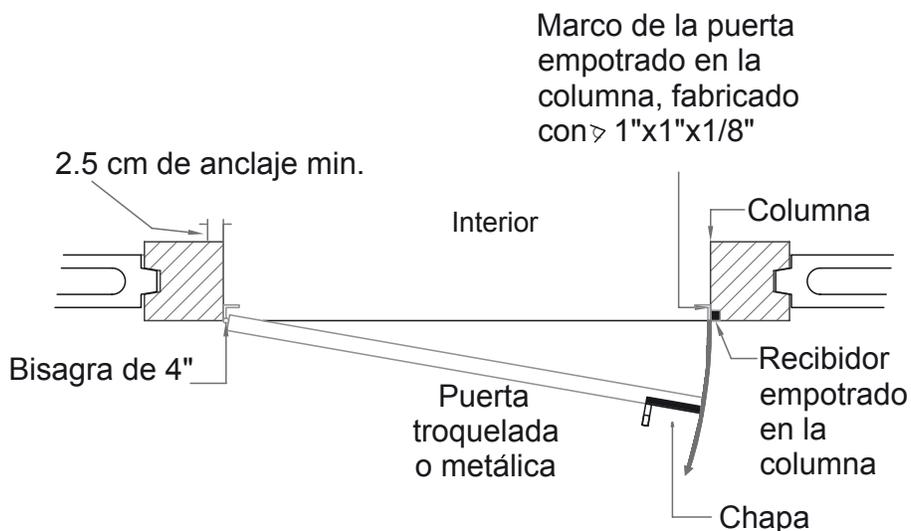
Puerta con giro hacia el exterior y recibidor en columna.
